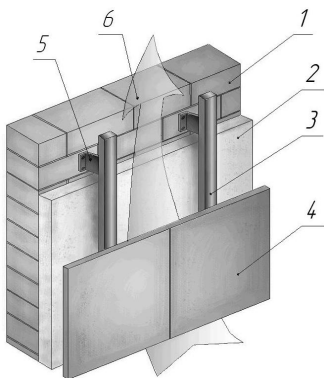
Основные элементы ограждающей конструкции с вентилируемой воздушной прослойкой: 1 – основной конструктивный слой (стена); 2 – слой теплоизоляции; 3 – направляющая рейка; 4 – облицовочный слой; 5 – кронштейн; 6 – поток воздуха в воздушной прослойке (стрелка указывает направление движения потока воздуха).
